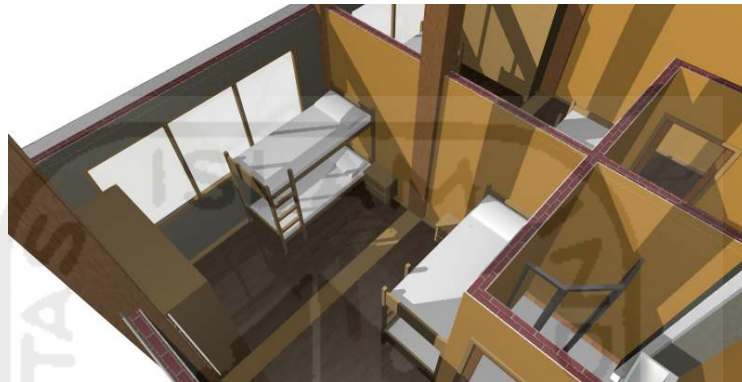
Skematik layout tata ruang kamar lodging house
